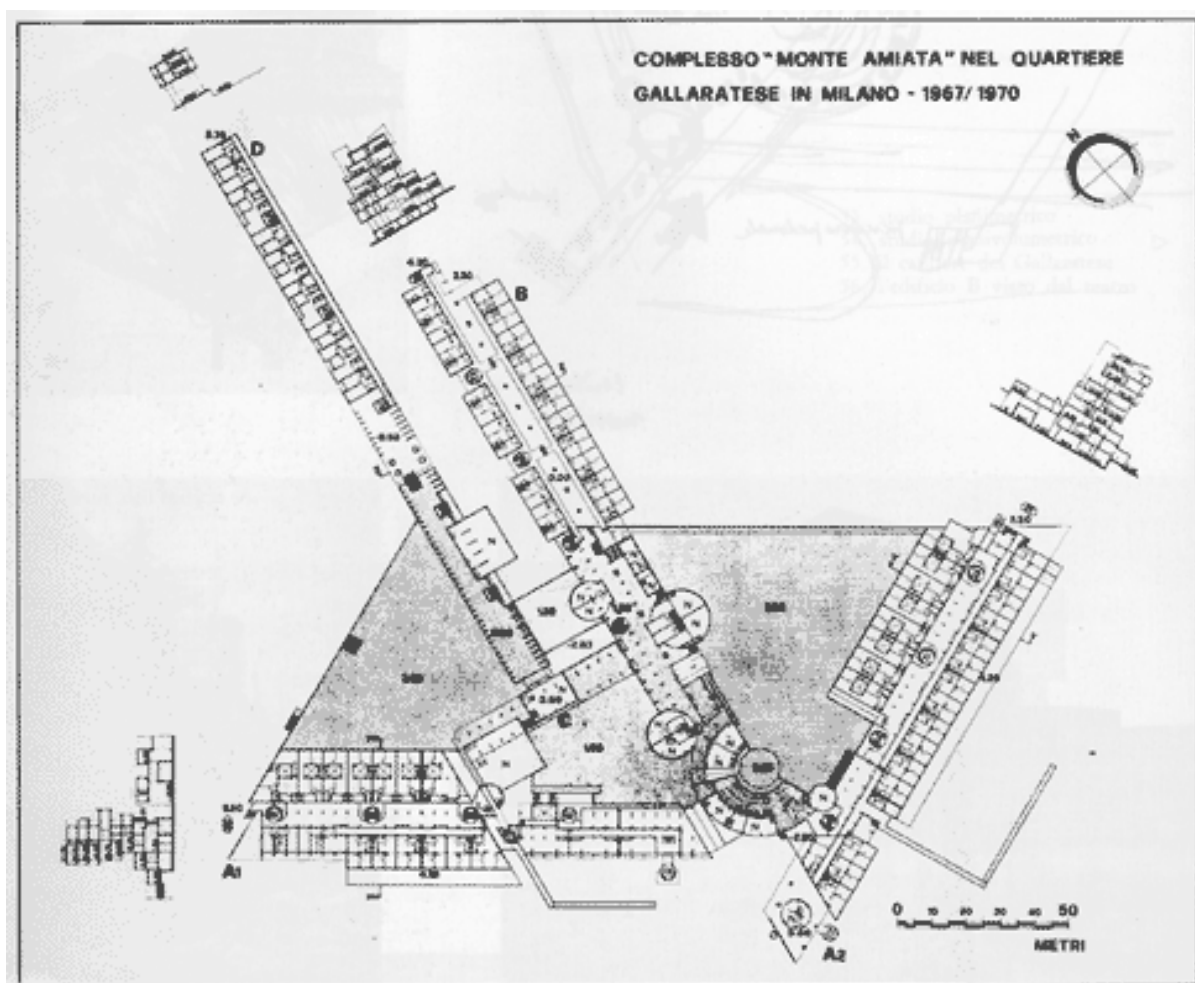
Pianta piano terra del quartiere Gallaratese in Milano
